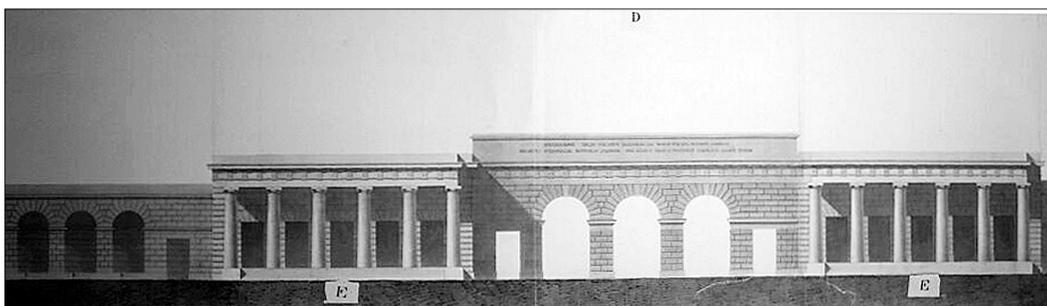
, Pietro Nobile (zugeschrieben), Äußeres Burgtor (Detail), Projekt D, Aufriss Stadtseite mit
